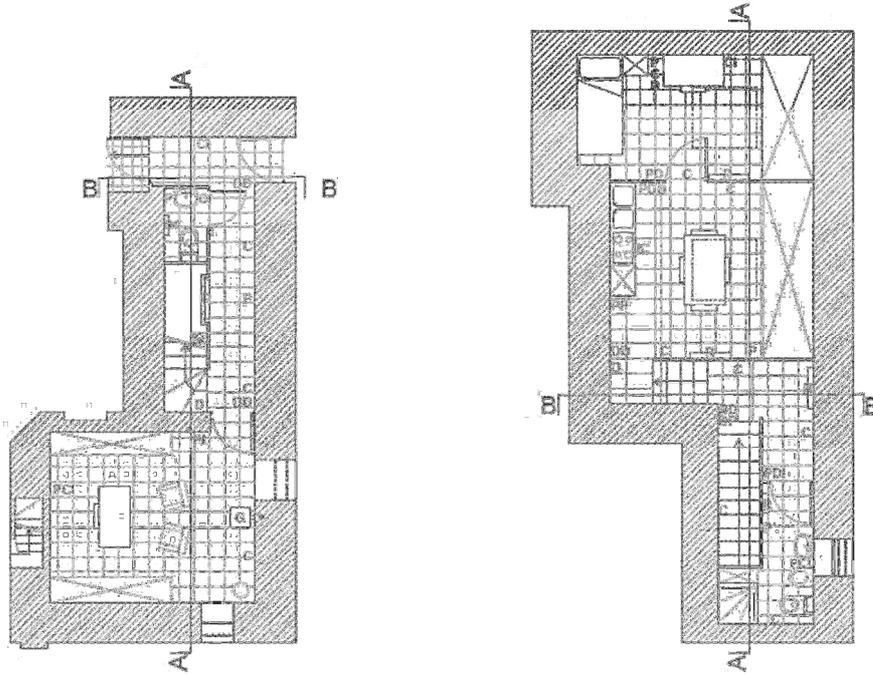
Pianti di progetto piani terra e primo dei locali laterali (Fonte: Tavola 3F)
